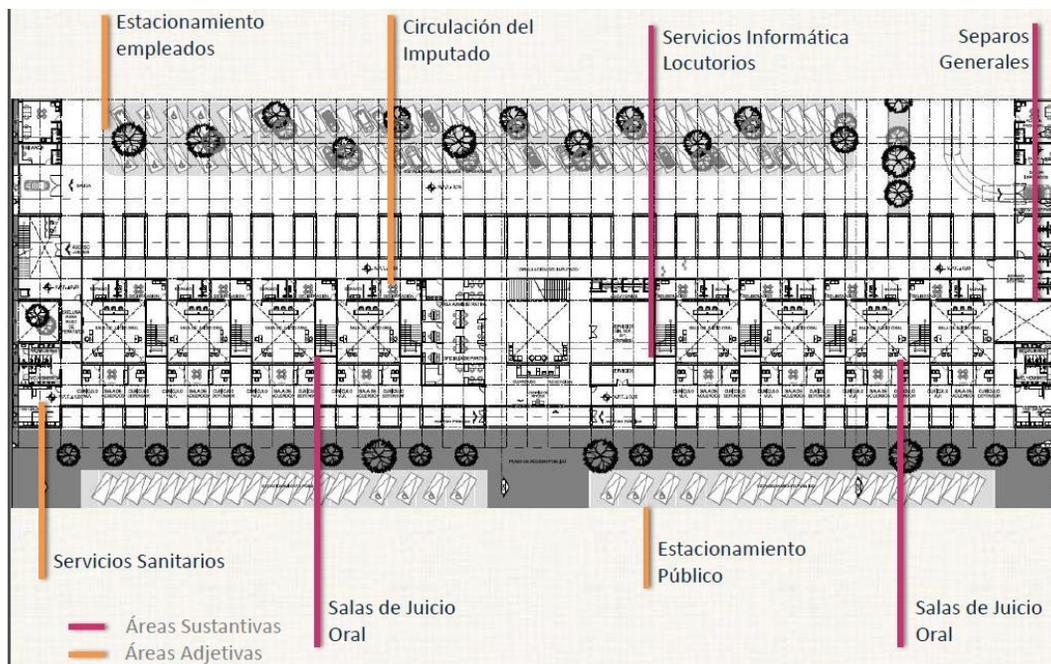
Planta arquitectónica tipo de Juzgado de Juicio Oral.
